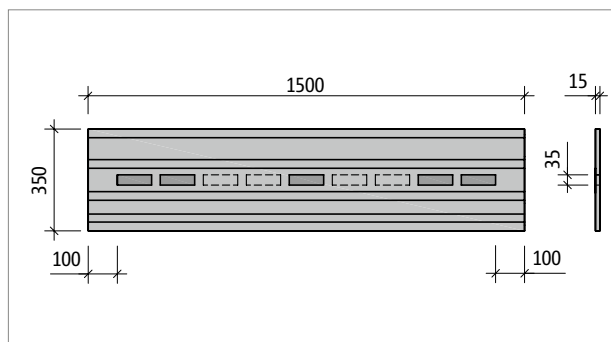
Tronsole® B-V1...-B350: Produktgrundriss
